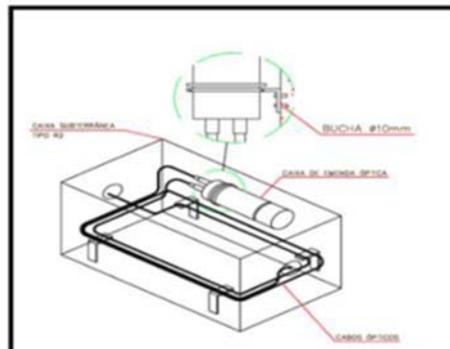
Instalação de caixa de emenda óptica em caixa subterrânea tipo R2
